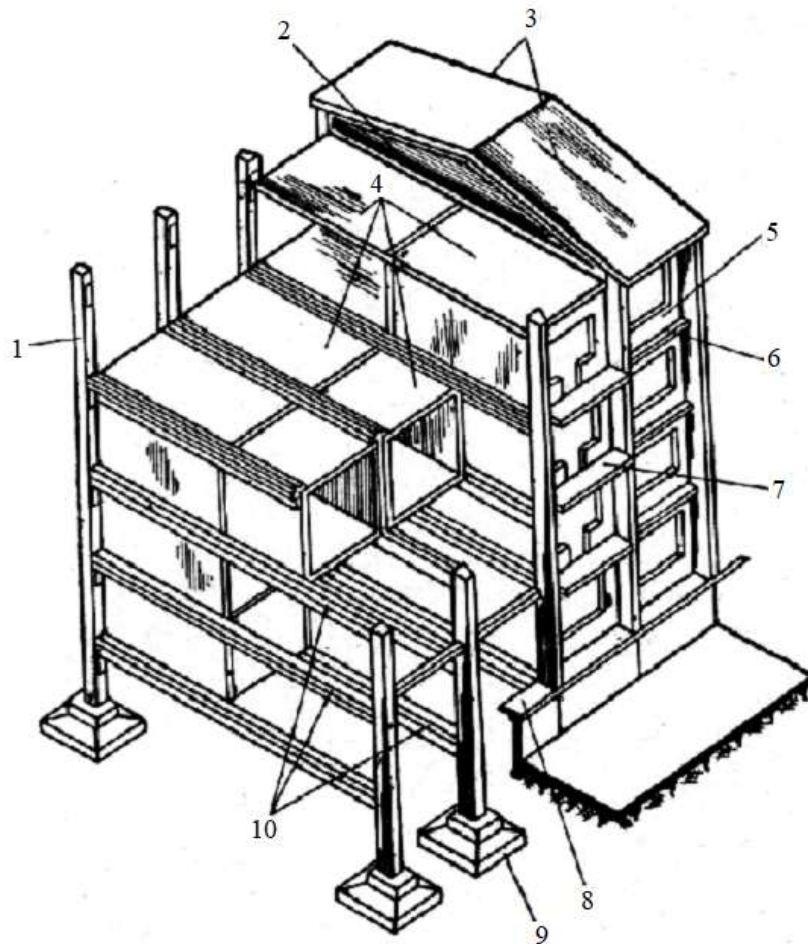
Каркасно-блочна схема будівель (стійки та об'ємні елементи обрізані умовно): 1 – залізобетонні стійки каркасу; 2 – залізобетонні балки; 3 – покрівельні плити; 4, 5 – об'ємні елементи; 6 – зв'язок каркасу; 7 – балконна плита; 8 – цокольна плита; 9 – фундаментна плита; 10 – залізобетонний ригель каркасу
